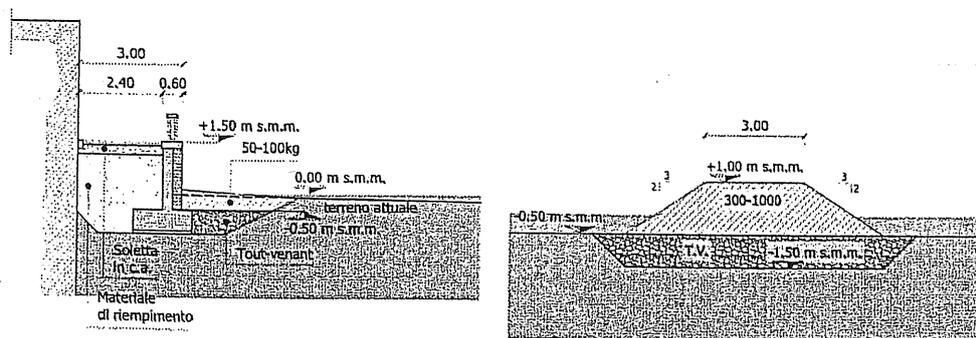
a e b. Sezioni tipo della banchina zona ovest e dei pennelli
